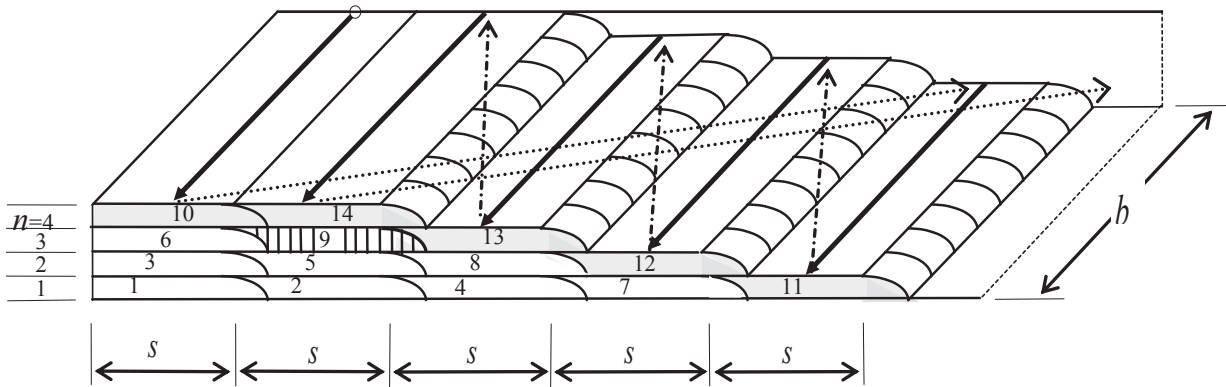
Betonowanie warstwami o długościach całego elementu, opis w tekście
